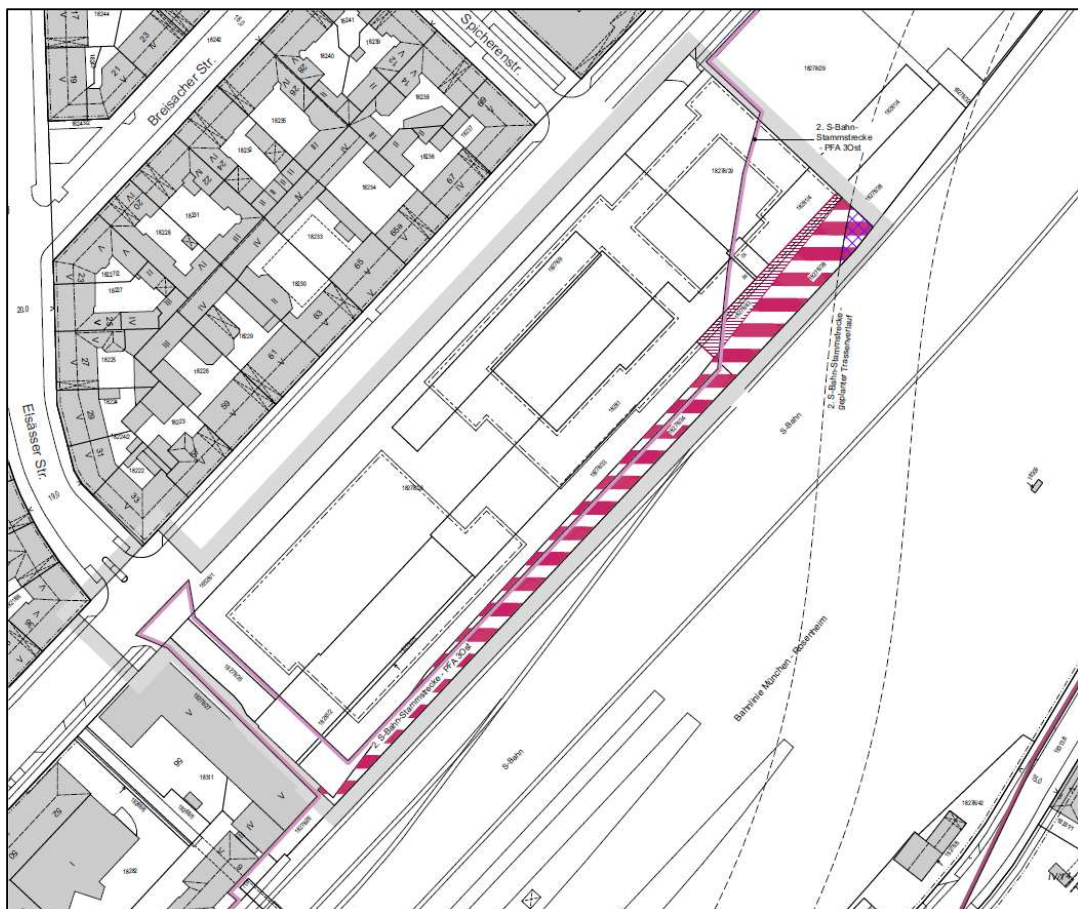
Planfeststellungsumgriff und bahnrrechtlich gewidmete Flächen (Dragomir Stadtplanung GmbH März 2023, Grundlage ©LHM)
